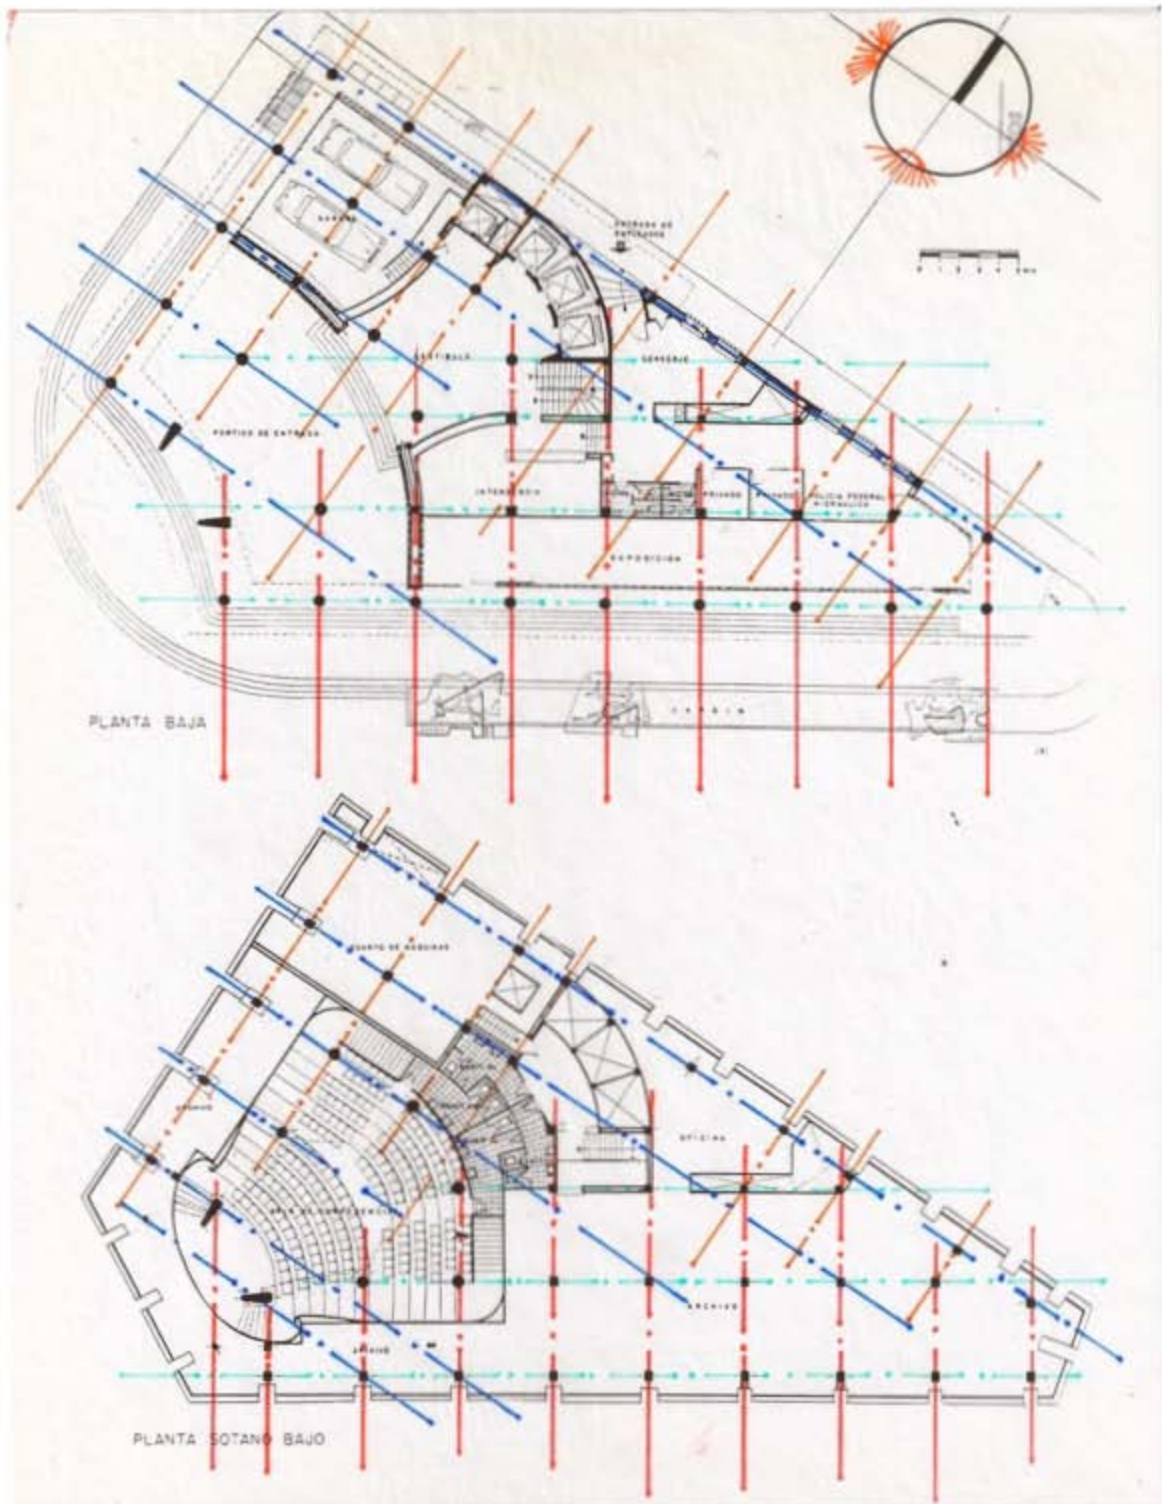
Alternativa A: Ejes compositivos ortogonales de las plantas arquitectónicas, en la imagen planta baja accesos y planta sótano bajo, se localiza auditorio
